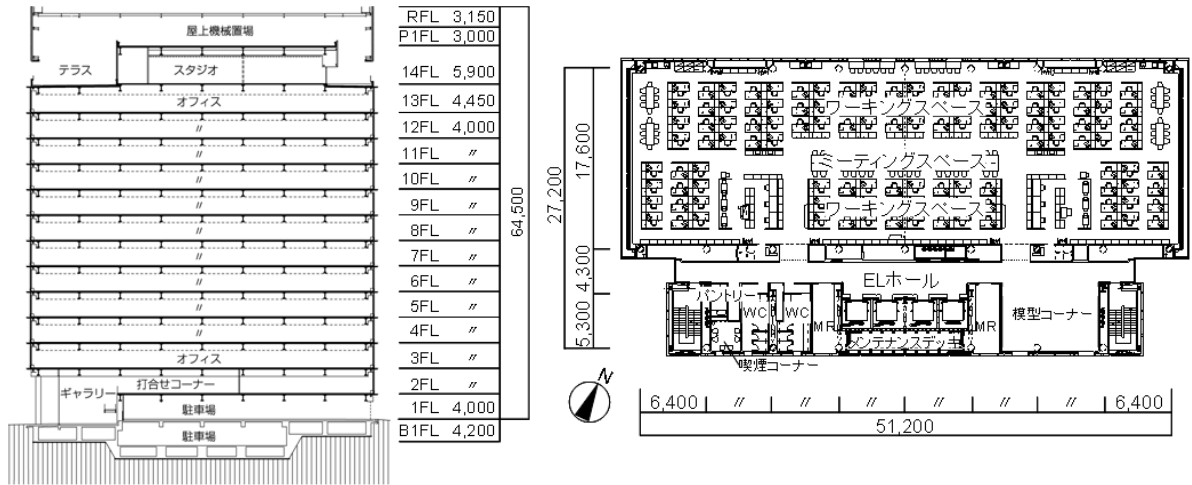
Aビルの断面図(左)と基準階平面図(右)
